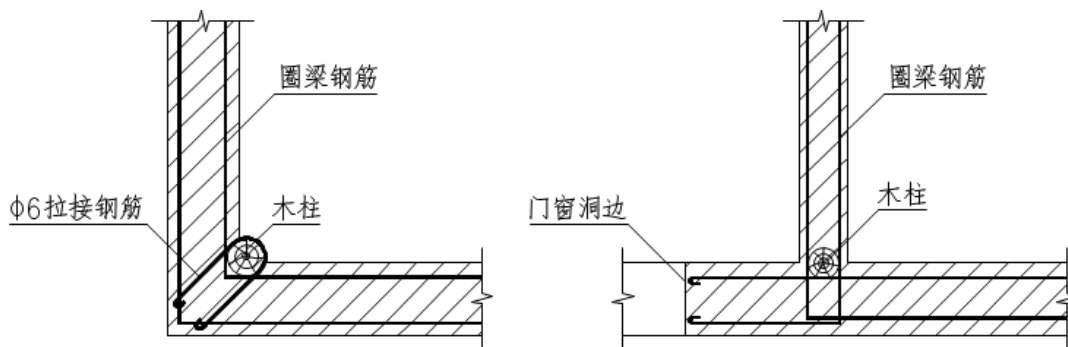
配筋砖圈梁、配筋砂浆带与木柱的拉结
